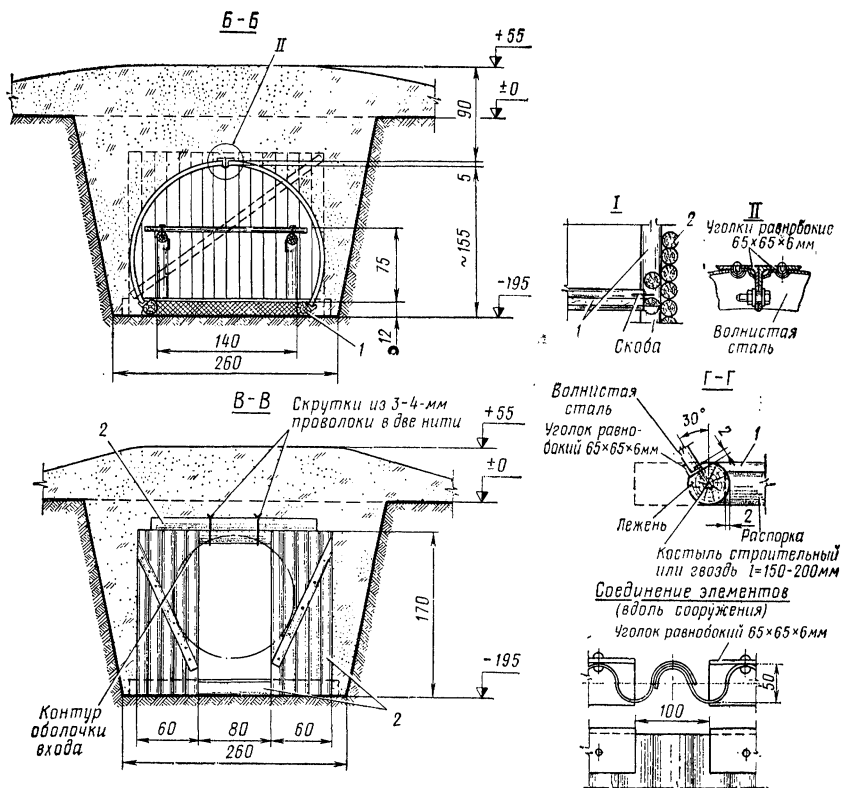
Блиндаж шитовой конструкции (разрезы)
